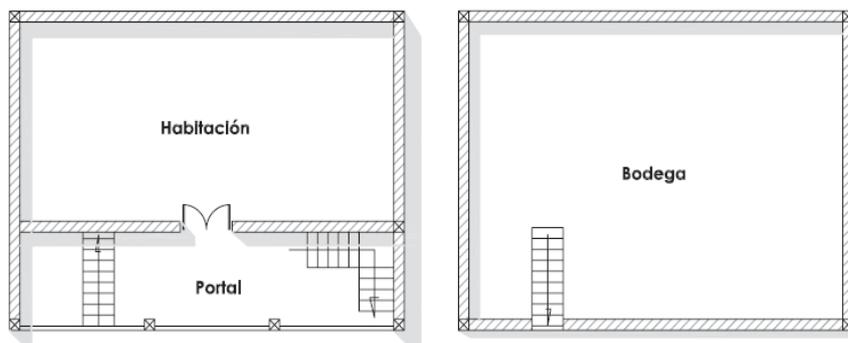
Planta Alta y Buhardilla Vivienda Tipología 7
